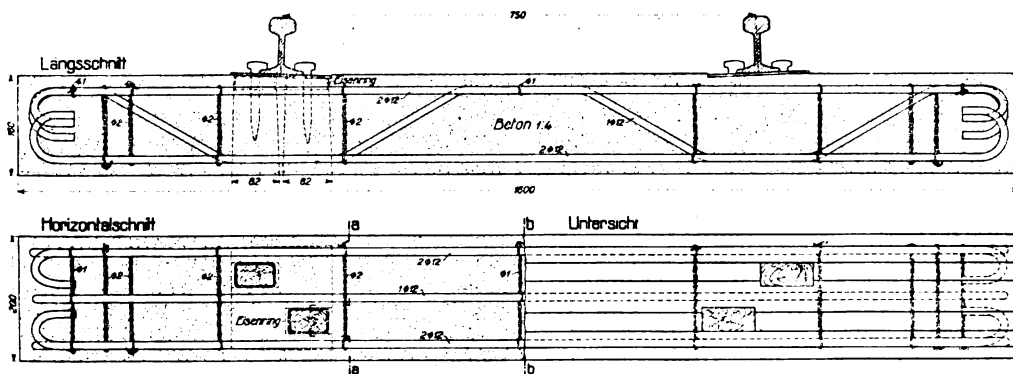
und 2. Schnitte und Draufsicht der Eisenbeton-Schwelle. — Masstab 1:12.
